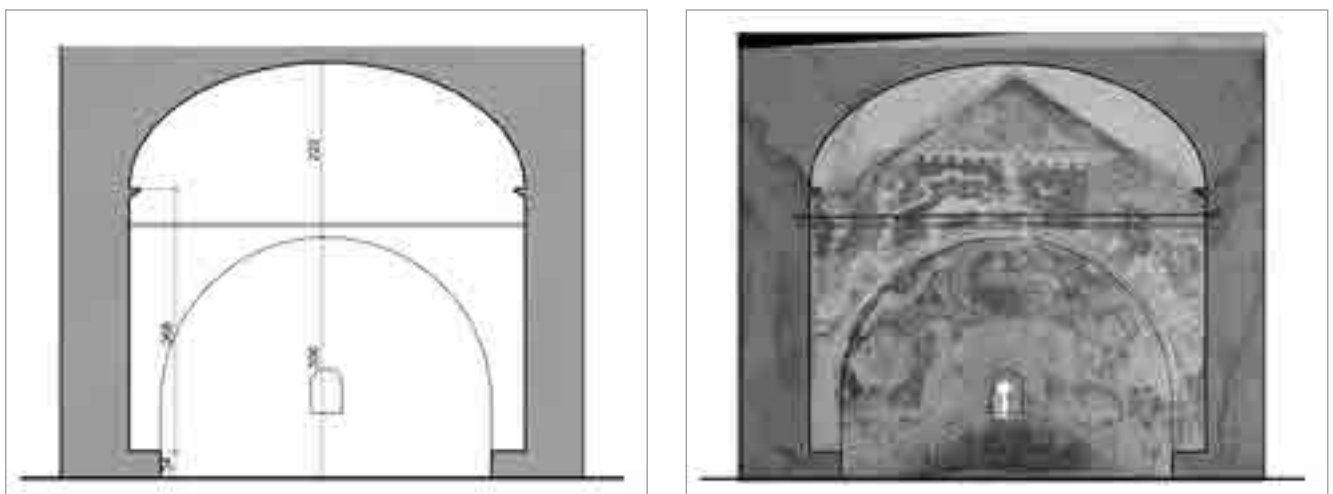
Sezione CC' quotata e con inserimento dell'ortoproiezione dell'abside.
